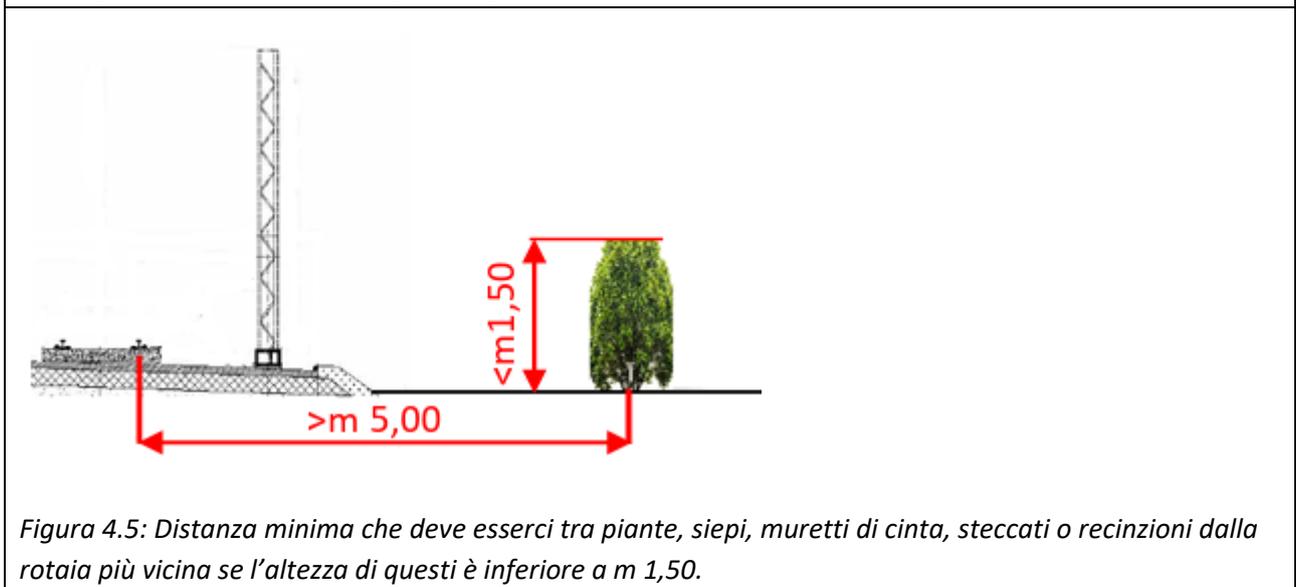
Distanza minima che deve esserci tra piante, siepi, muretti di cinta, steccati o recinzioni dalla rotaia più vicina se l'altezza di questi è inferiore a m 1,50.
